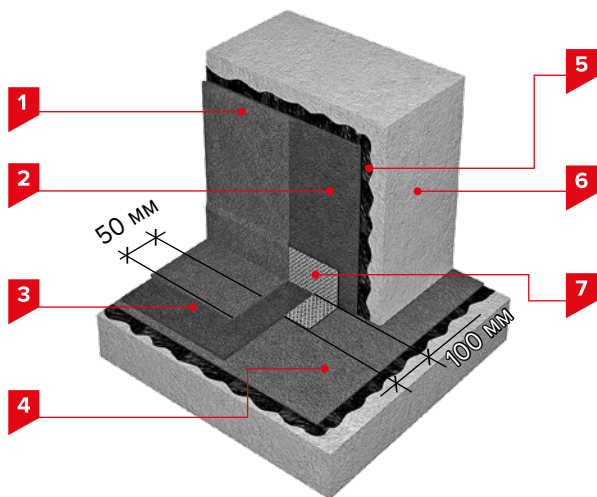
Техноэласт Фундамент. Обустройство внутреннего угла без применения галтели при смене направления укладки гидроизоляционной мембраны:
